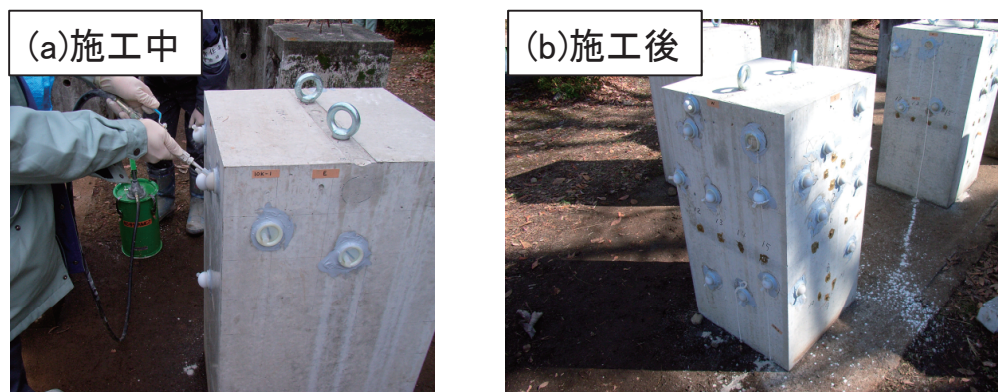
ASRが生じたコンクリート供試体へのひび割れ注入施工の様子
